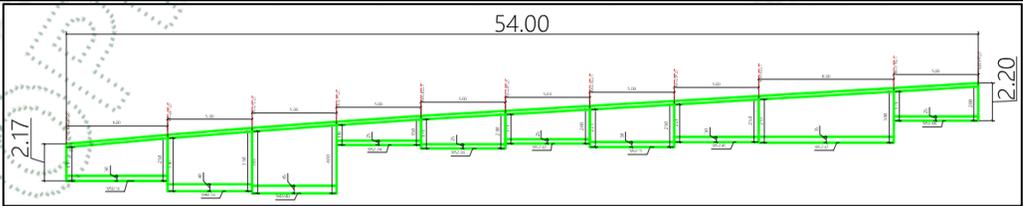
19 (87)		Tipo de la obra				Tubería abscisa K06+270
